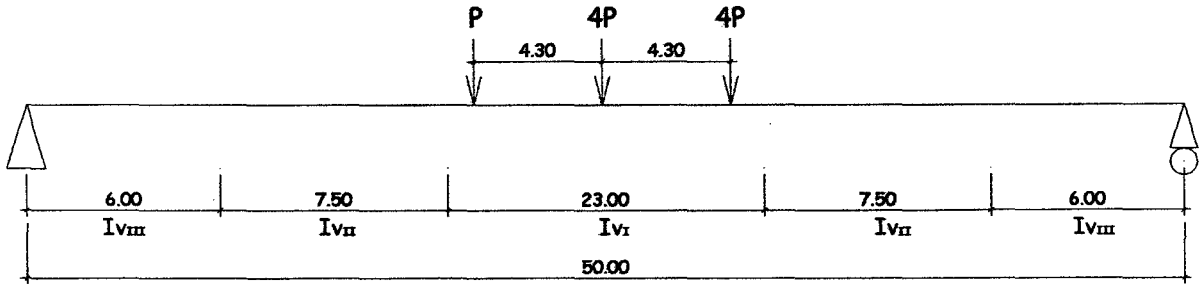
Distribución de S/C Vehicular en las Vigas
